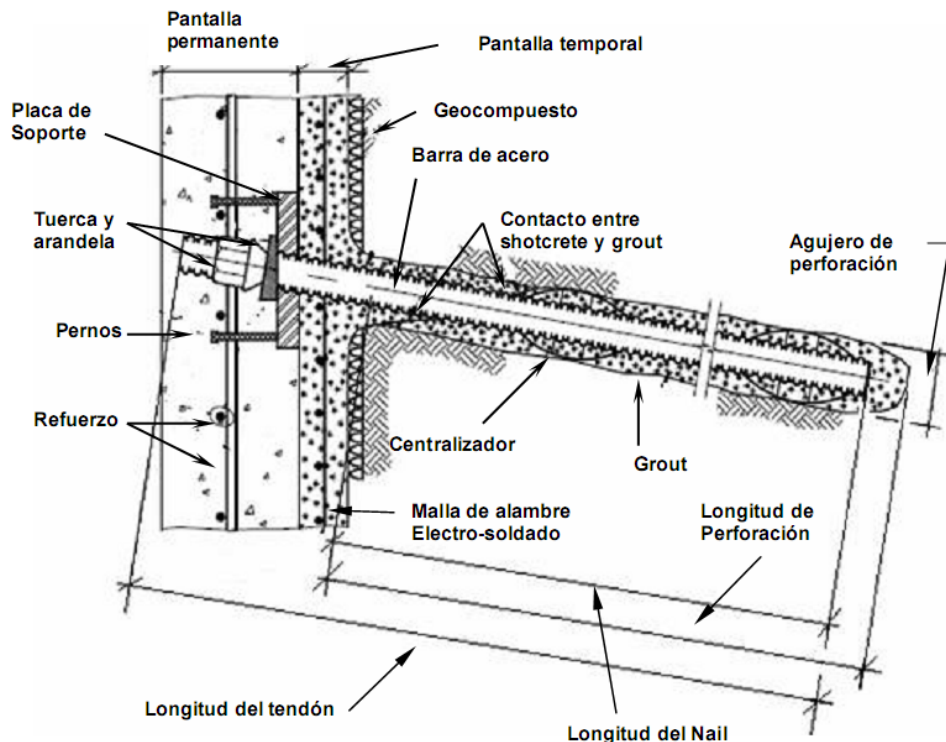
Componentes de un Muro Soil Nailing.
